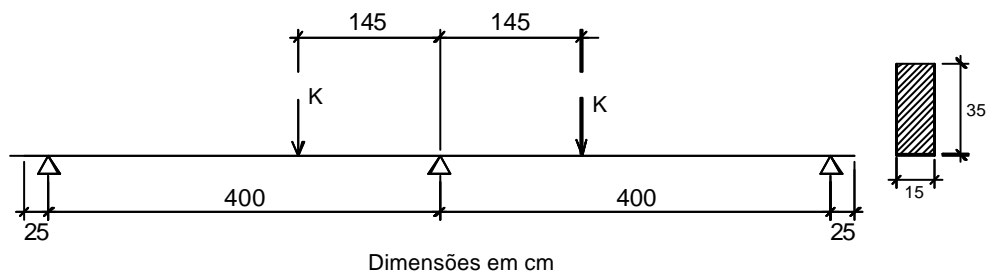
Esquema estrutural da viga do exemplo 3
